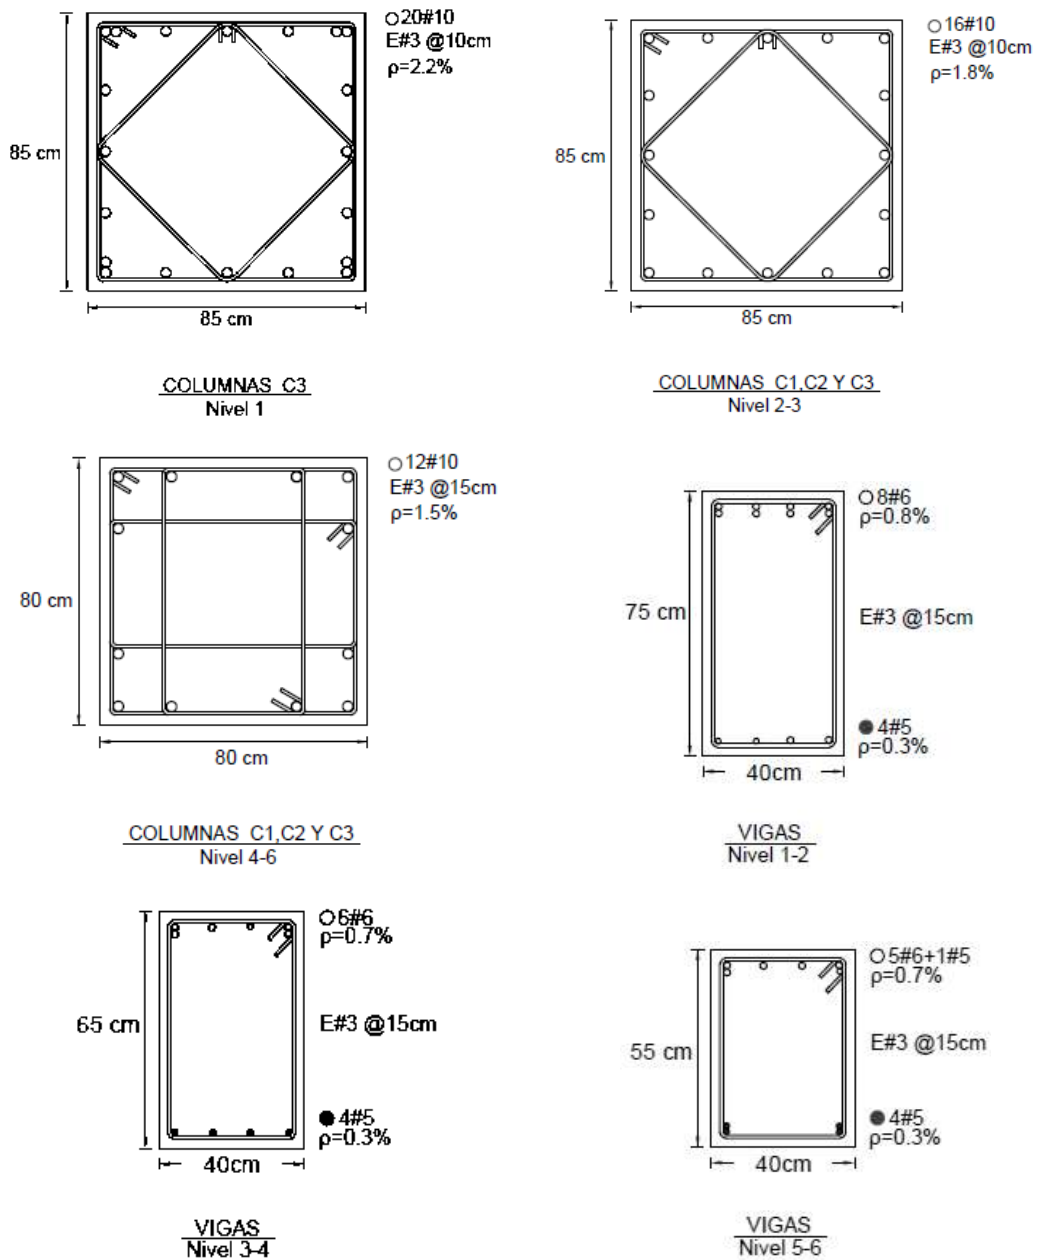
Armado de vigas y columnas diseñadas con las NTCC-04 para el edificio de 6 niveles con un sistema estructural a base de marcos dúctiles
